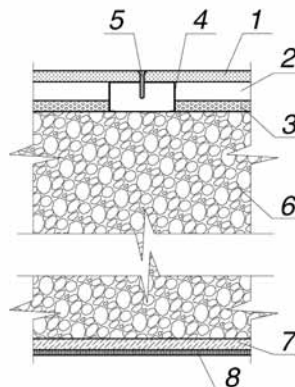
Фрагмент расчетной схемы утепленной наружной стены: 1 – гипсокартонные листы; 2 – воздушная прослойка; 3 – пенофол; 4 – металлический профиль; 5 – саморез; 6 – кладка из керамзитовых камней на цементно-песчаном растворе; 7 – цементно-песчаный раствор; 8 – фактурное покрытие фасадной системы
